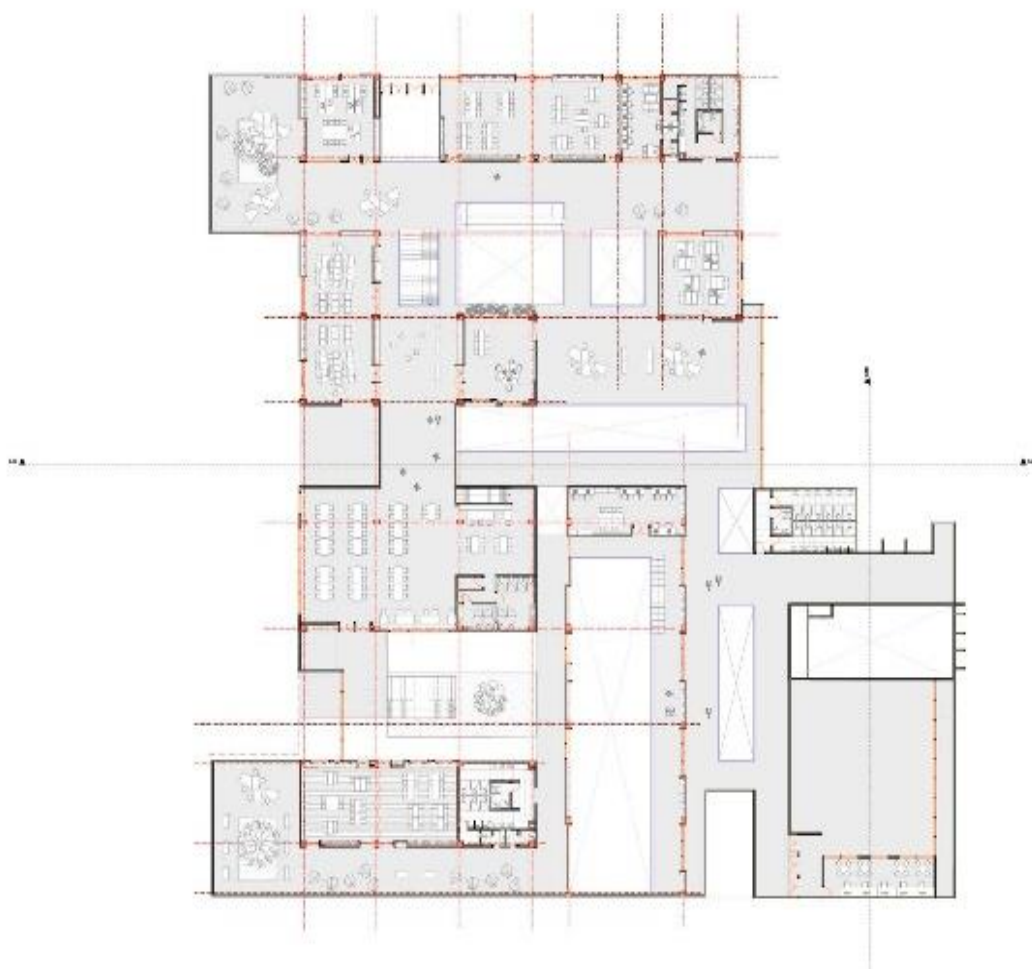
Planta Proyecto Decimo Semestre /Planta 2do Nivel Centro Ambiental Colegio Leonardo Posada Pedraza
